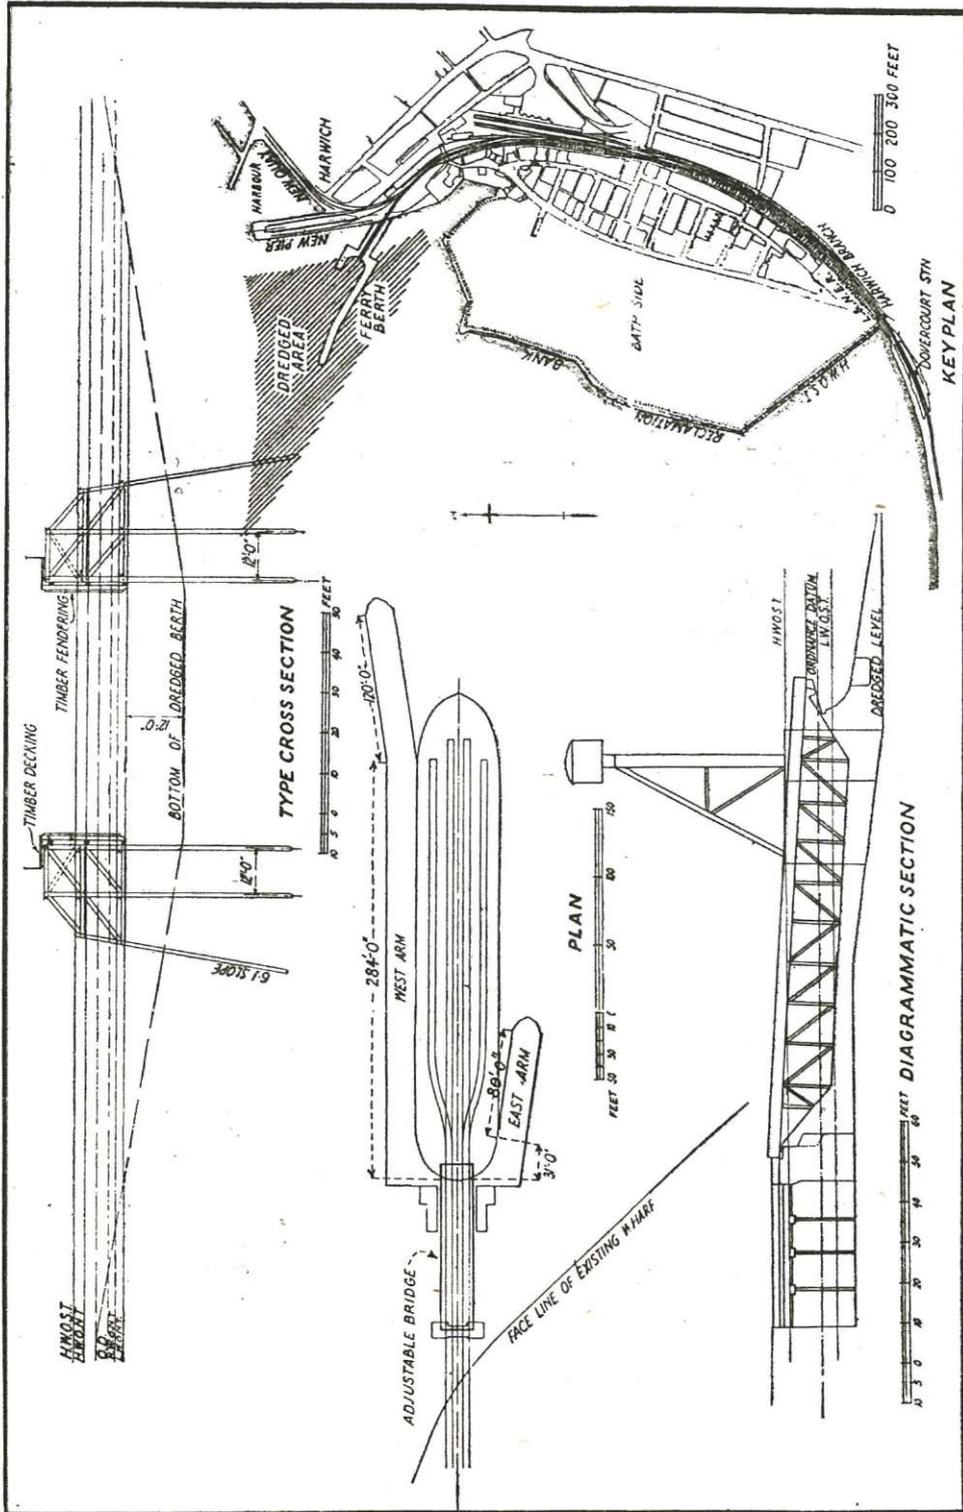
Le nouveau mouillage pour bacs à trains à Harwich : plans, coupe et élévation.
